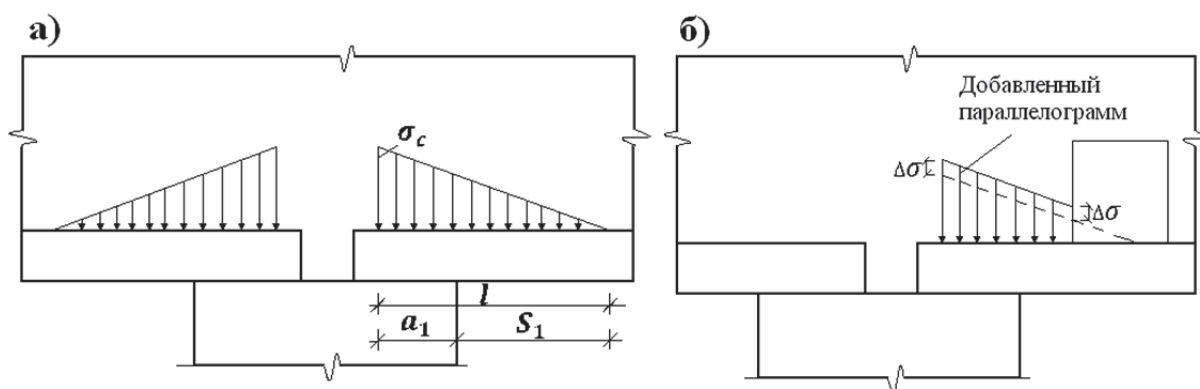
Нагрузка на однопролётные фундаментные балки:
